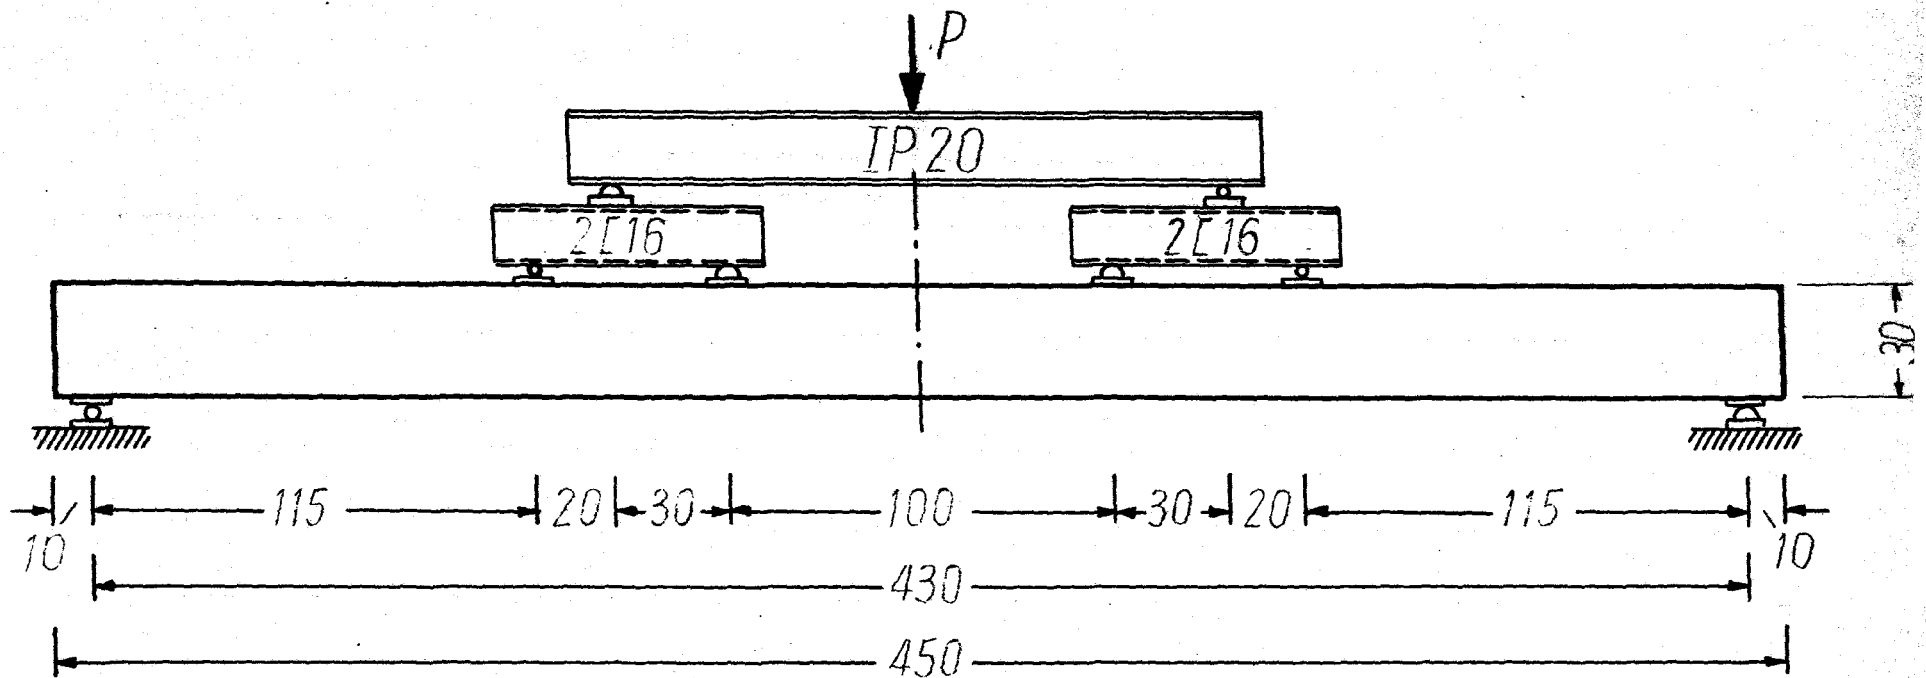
Belastungsvorrichtung für Balken aus Schwerbeton und Riegelplittbeton
